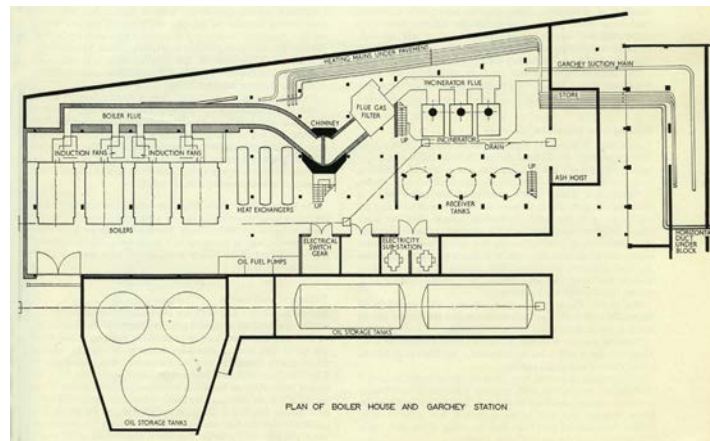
Planta de la central térmica y el Garchey Station. En RIBA Journal.
